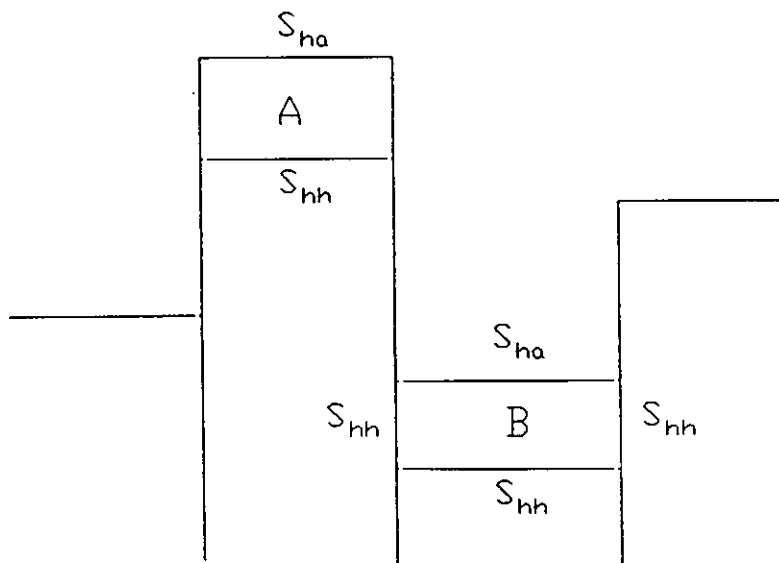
Sección-perfil de una presa de gravedad en fase de construcción.
